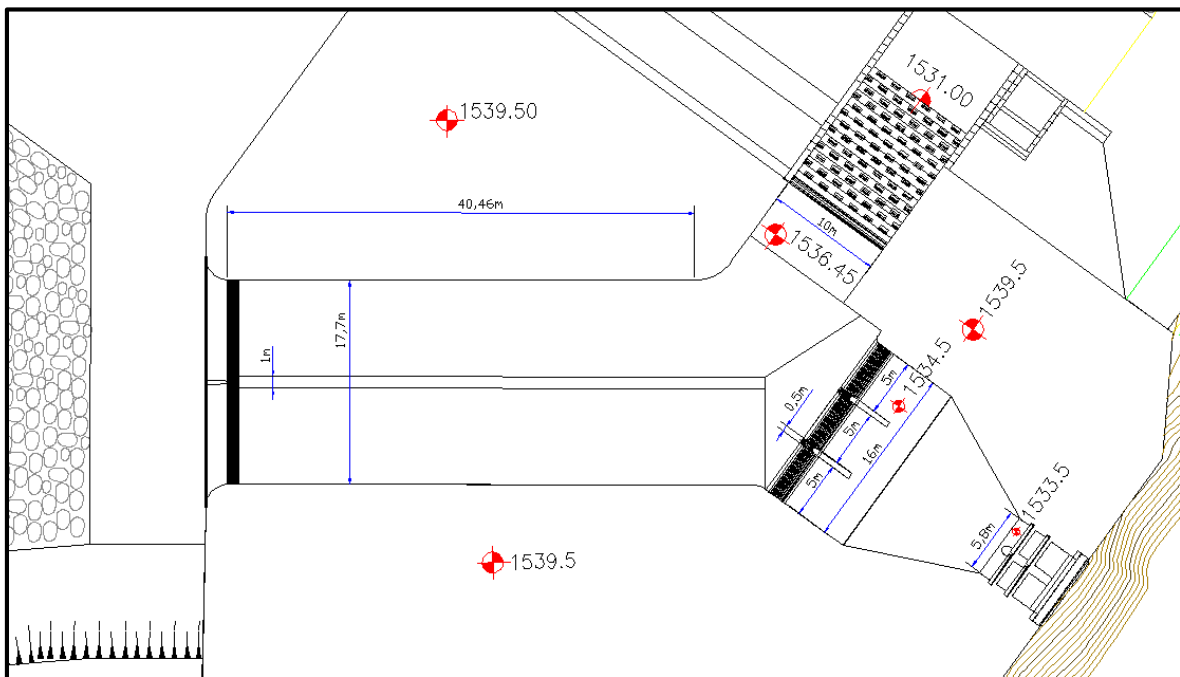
Vista en planta de las estructuras de captación y vertedero de demasías.
